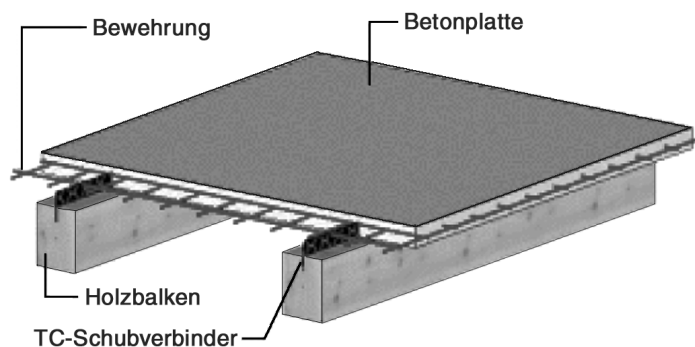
Schubverbund mit eingeklebten Gitterblechen nach [28]
